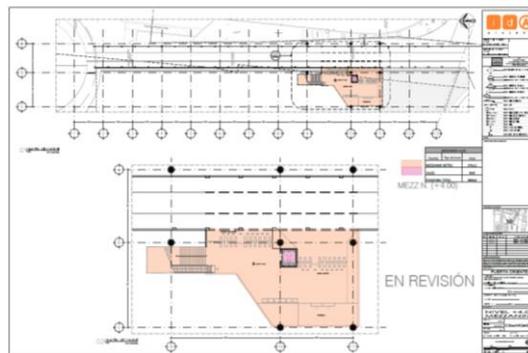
Nivel Mezanine (+4.00), Conexión con el Puente del Metro Línea 1 y B. Fuente: Puerta Oriente por IDA Projekt.
